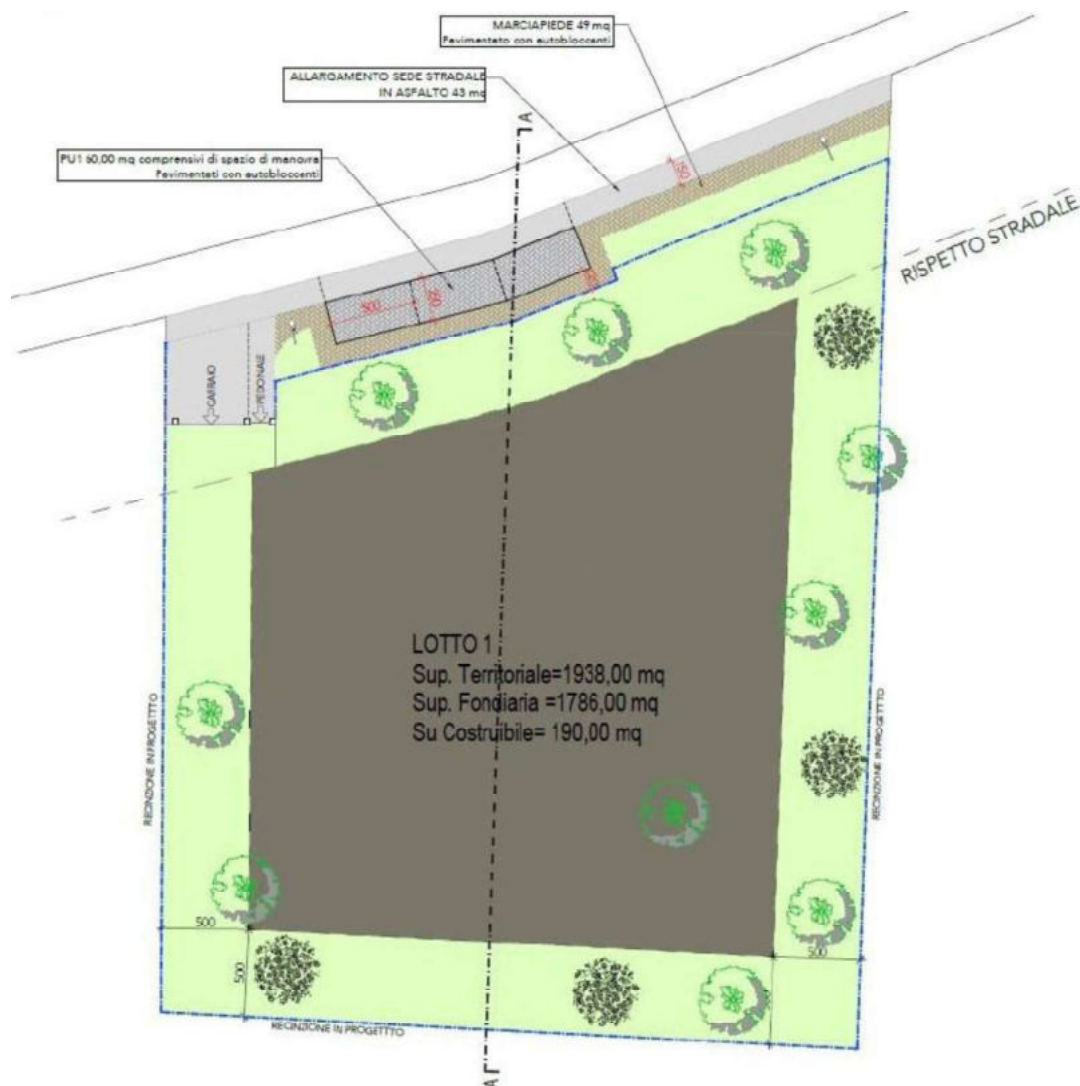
Planimetria urbanizzazione con indicazione delle aree di cessione
